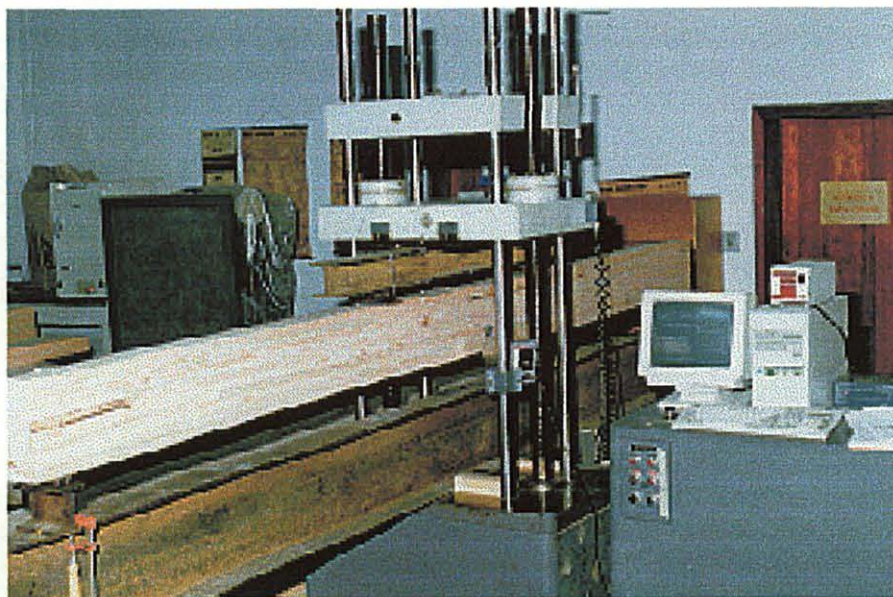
MÁQUINA DE ENSAIO UNIVERSAL
